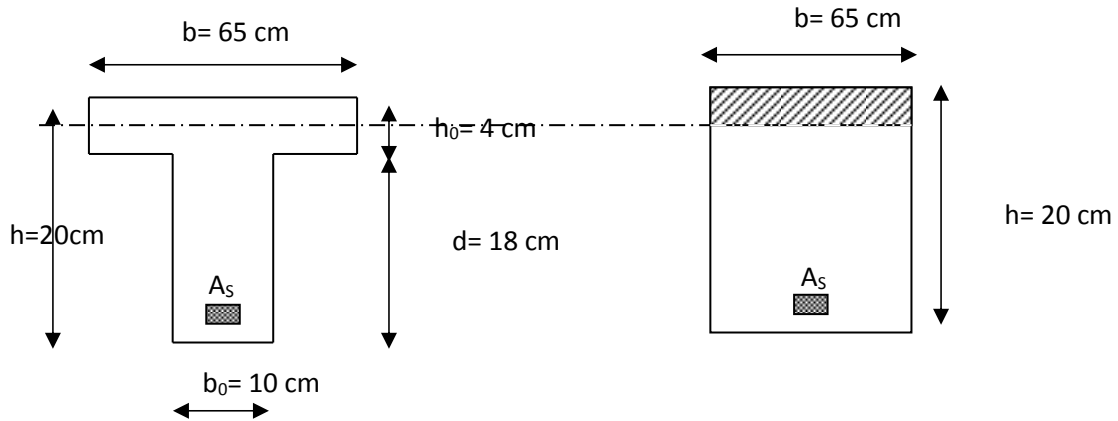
Coupe de Section Rectangulaire et Section en T
